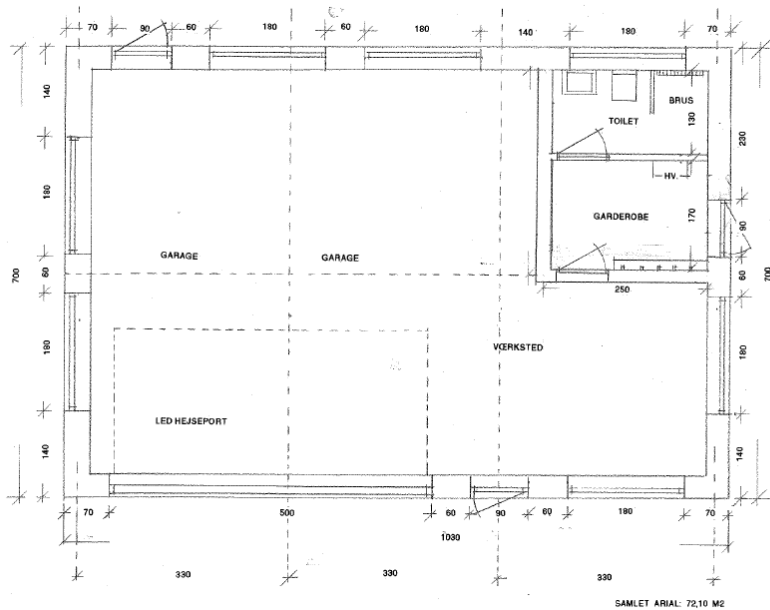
plantegning (se bort fra garderobe og bad, da disse er taget ud af projektet)
